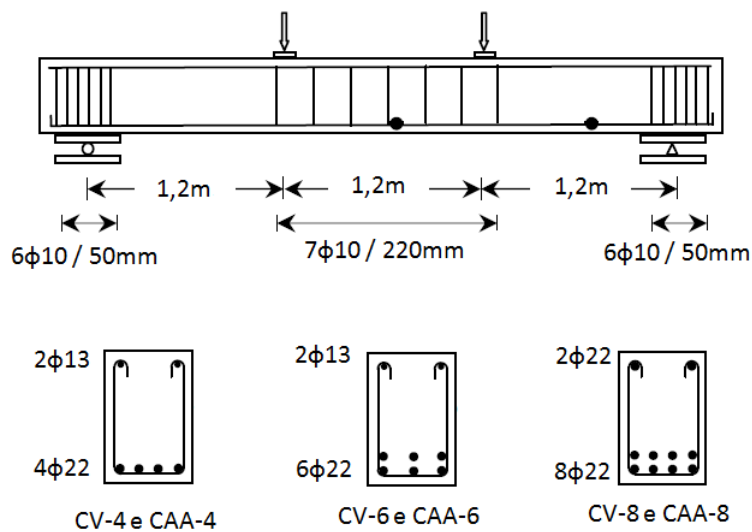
Esquema do ensaio e seção transversal das vigas de
